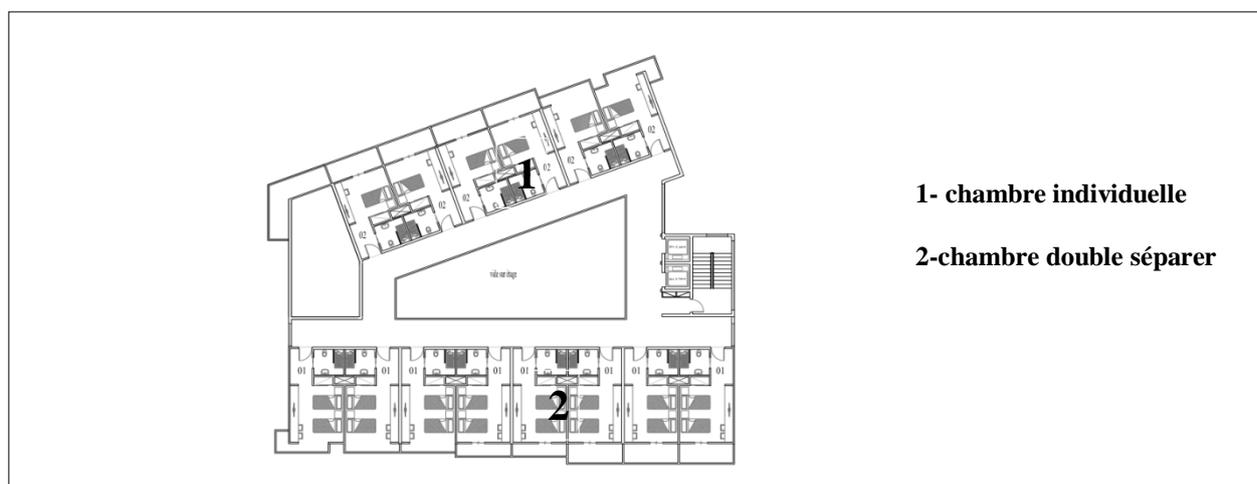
plan du chambre type 01, (Source : auteur 2018)
